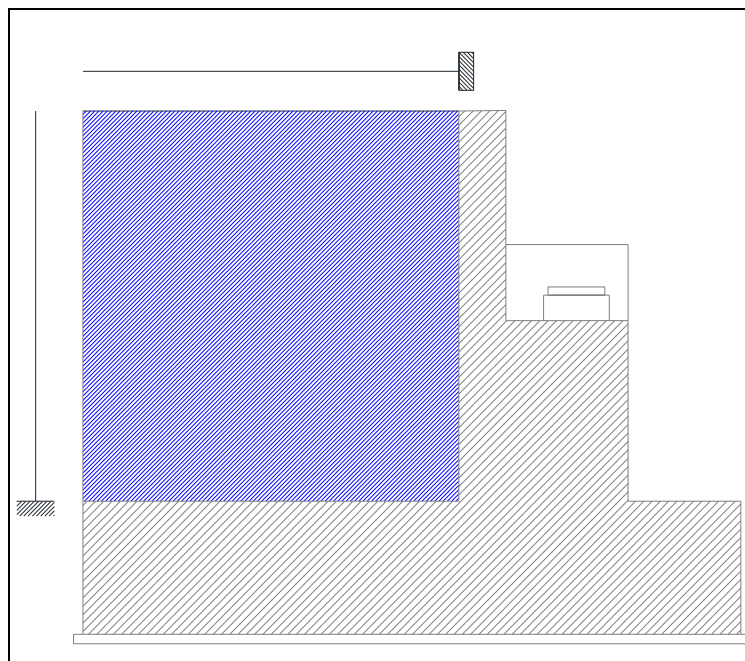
Spalla A - Schema statico equivalente adottato per muro andatore
